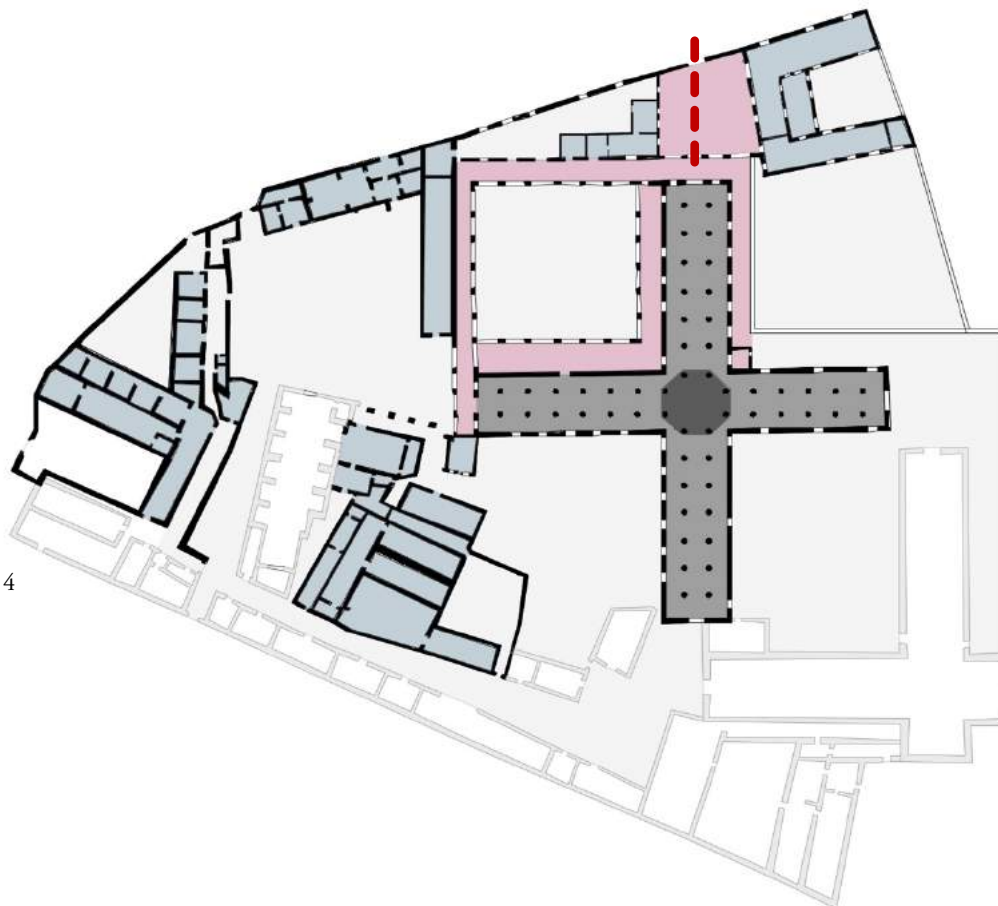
Hospital Real de Granada. Esquema en planta baja propuesto del estado constructivo a finales del siglo XVI
